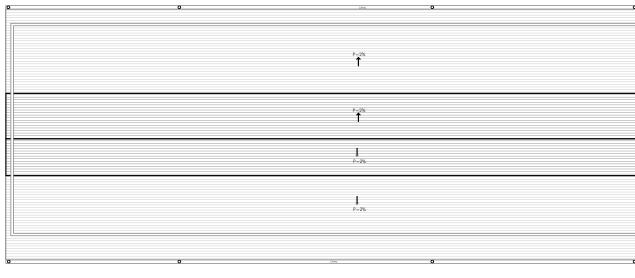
Planta Cubiertas Zona Porcina Fuente: Autor
